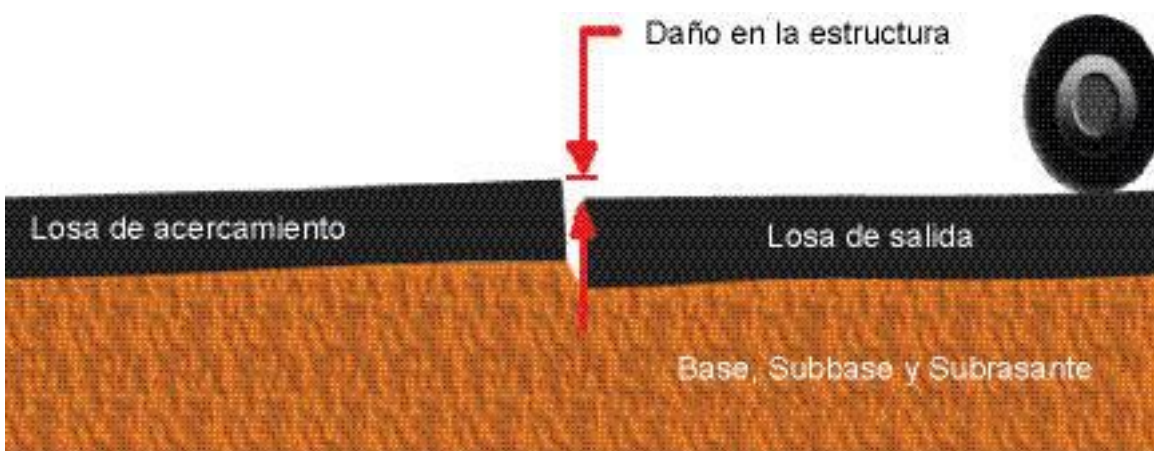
b.8 Daño por efectos del bombeo en pavimentos rígidos.
